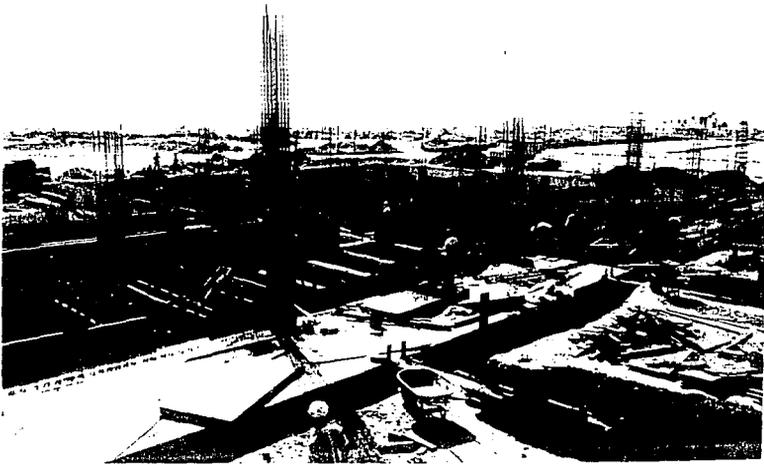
CIMENTACIÓN. LEVANTAMIENTO DE MUROS DE TABIQUE -
